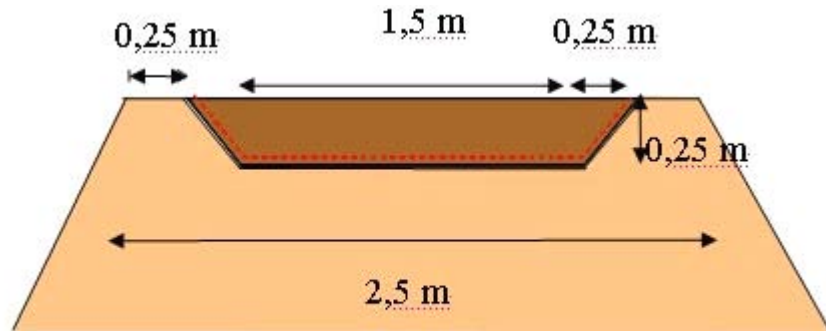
Coupe de la planche d'essai dans le plan perpendiculaire à la pente.
